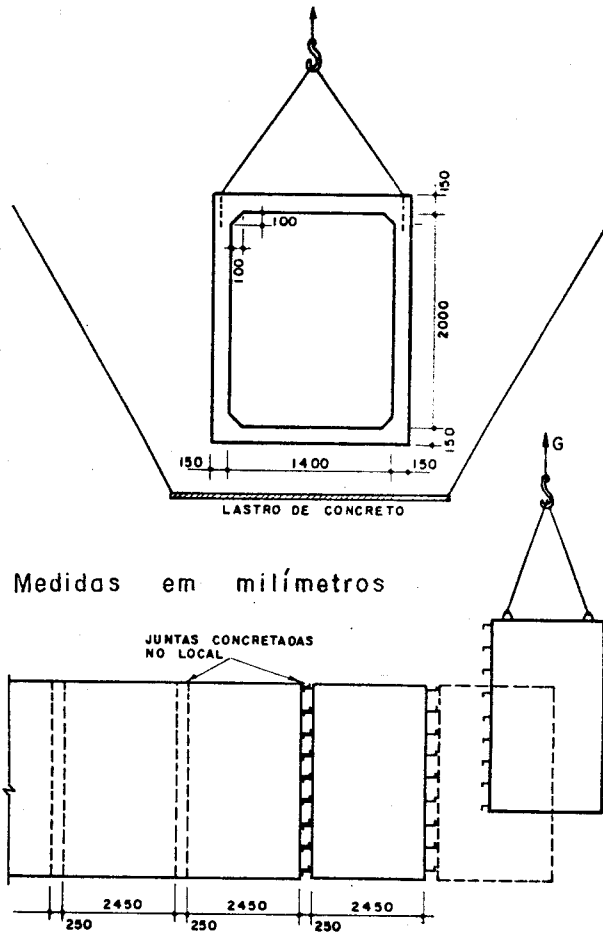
Construção de galeria de seção retangular com elementos pré-moldados.
